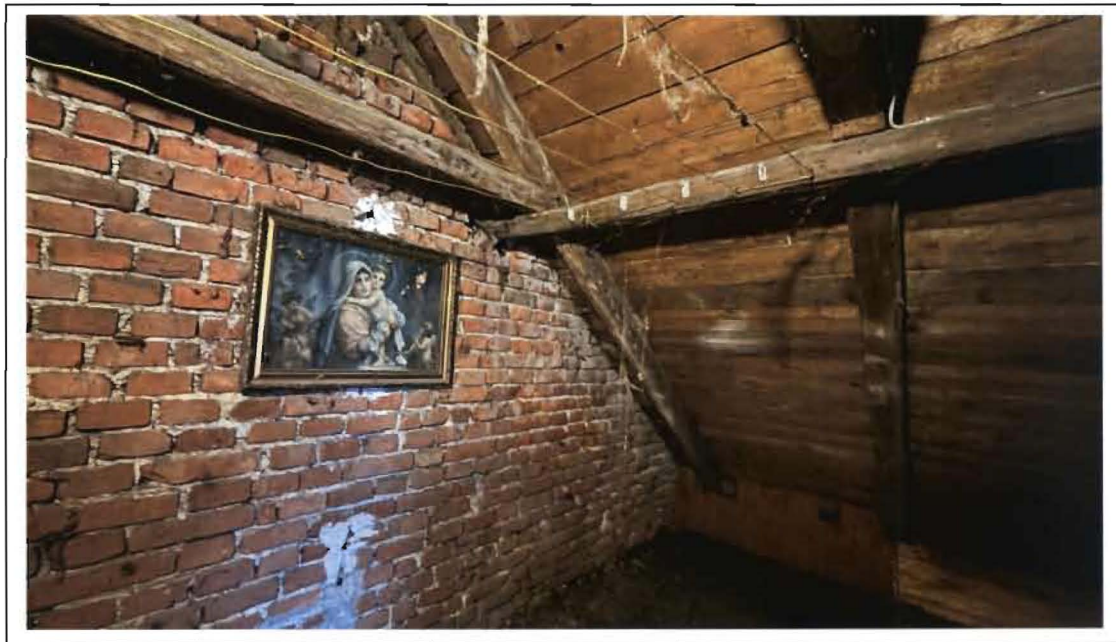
Blick in das Dachgeschoss (Hauptgebäude)
